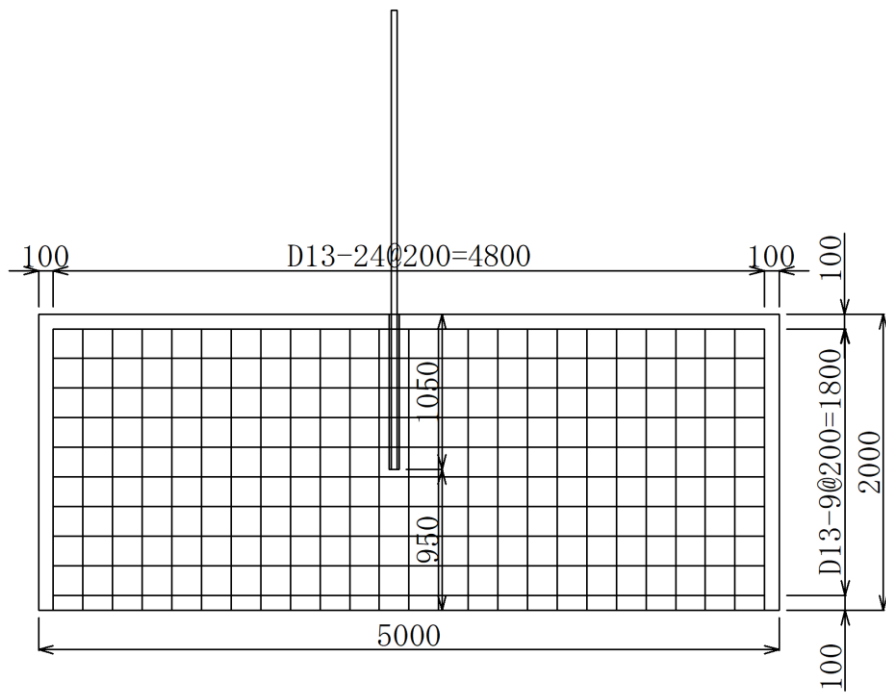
(8) 実験体②の配筋図 (C-C 断面図)
